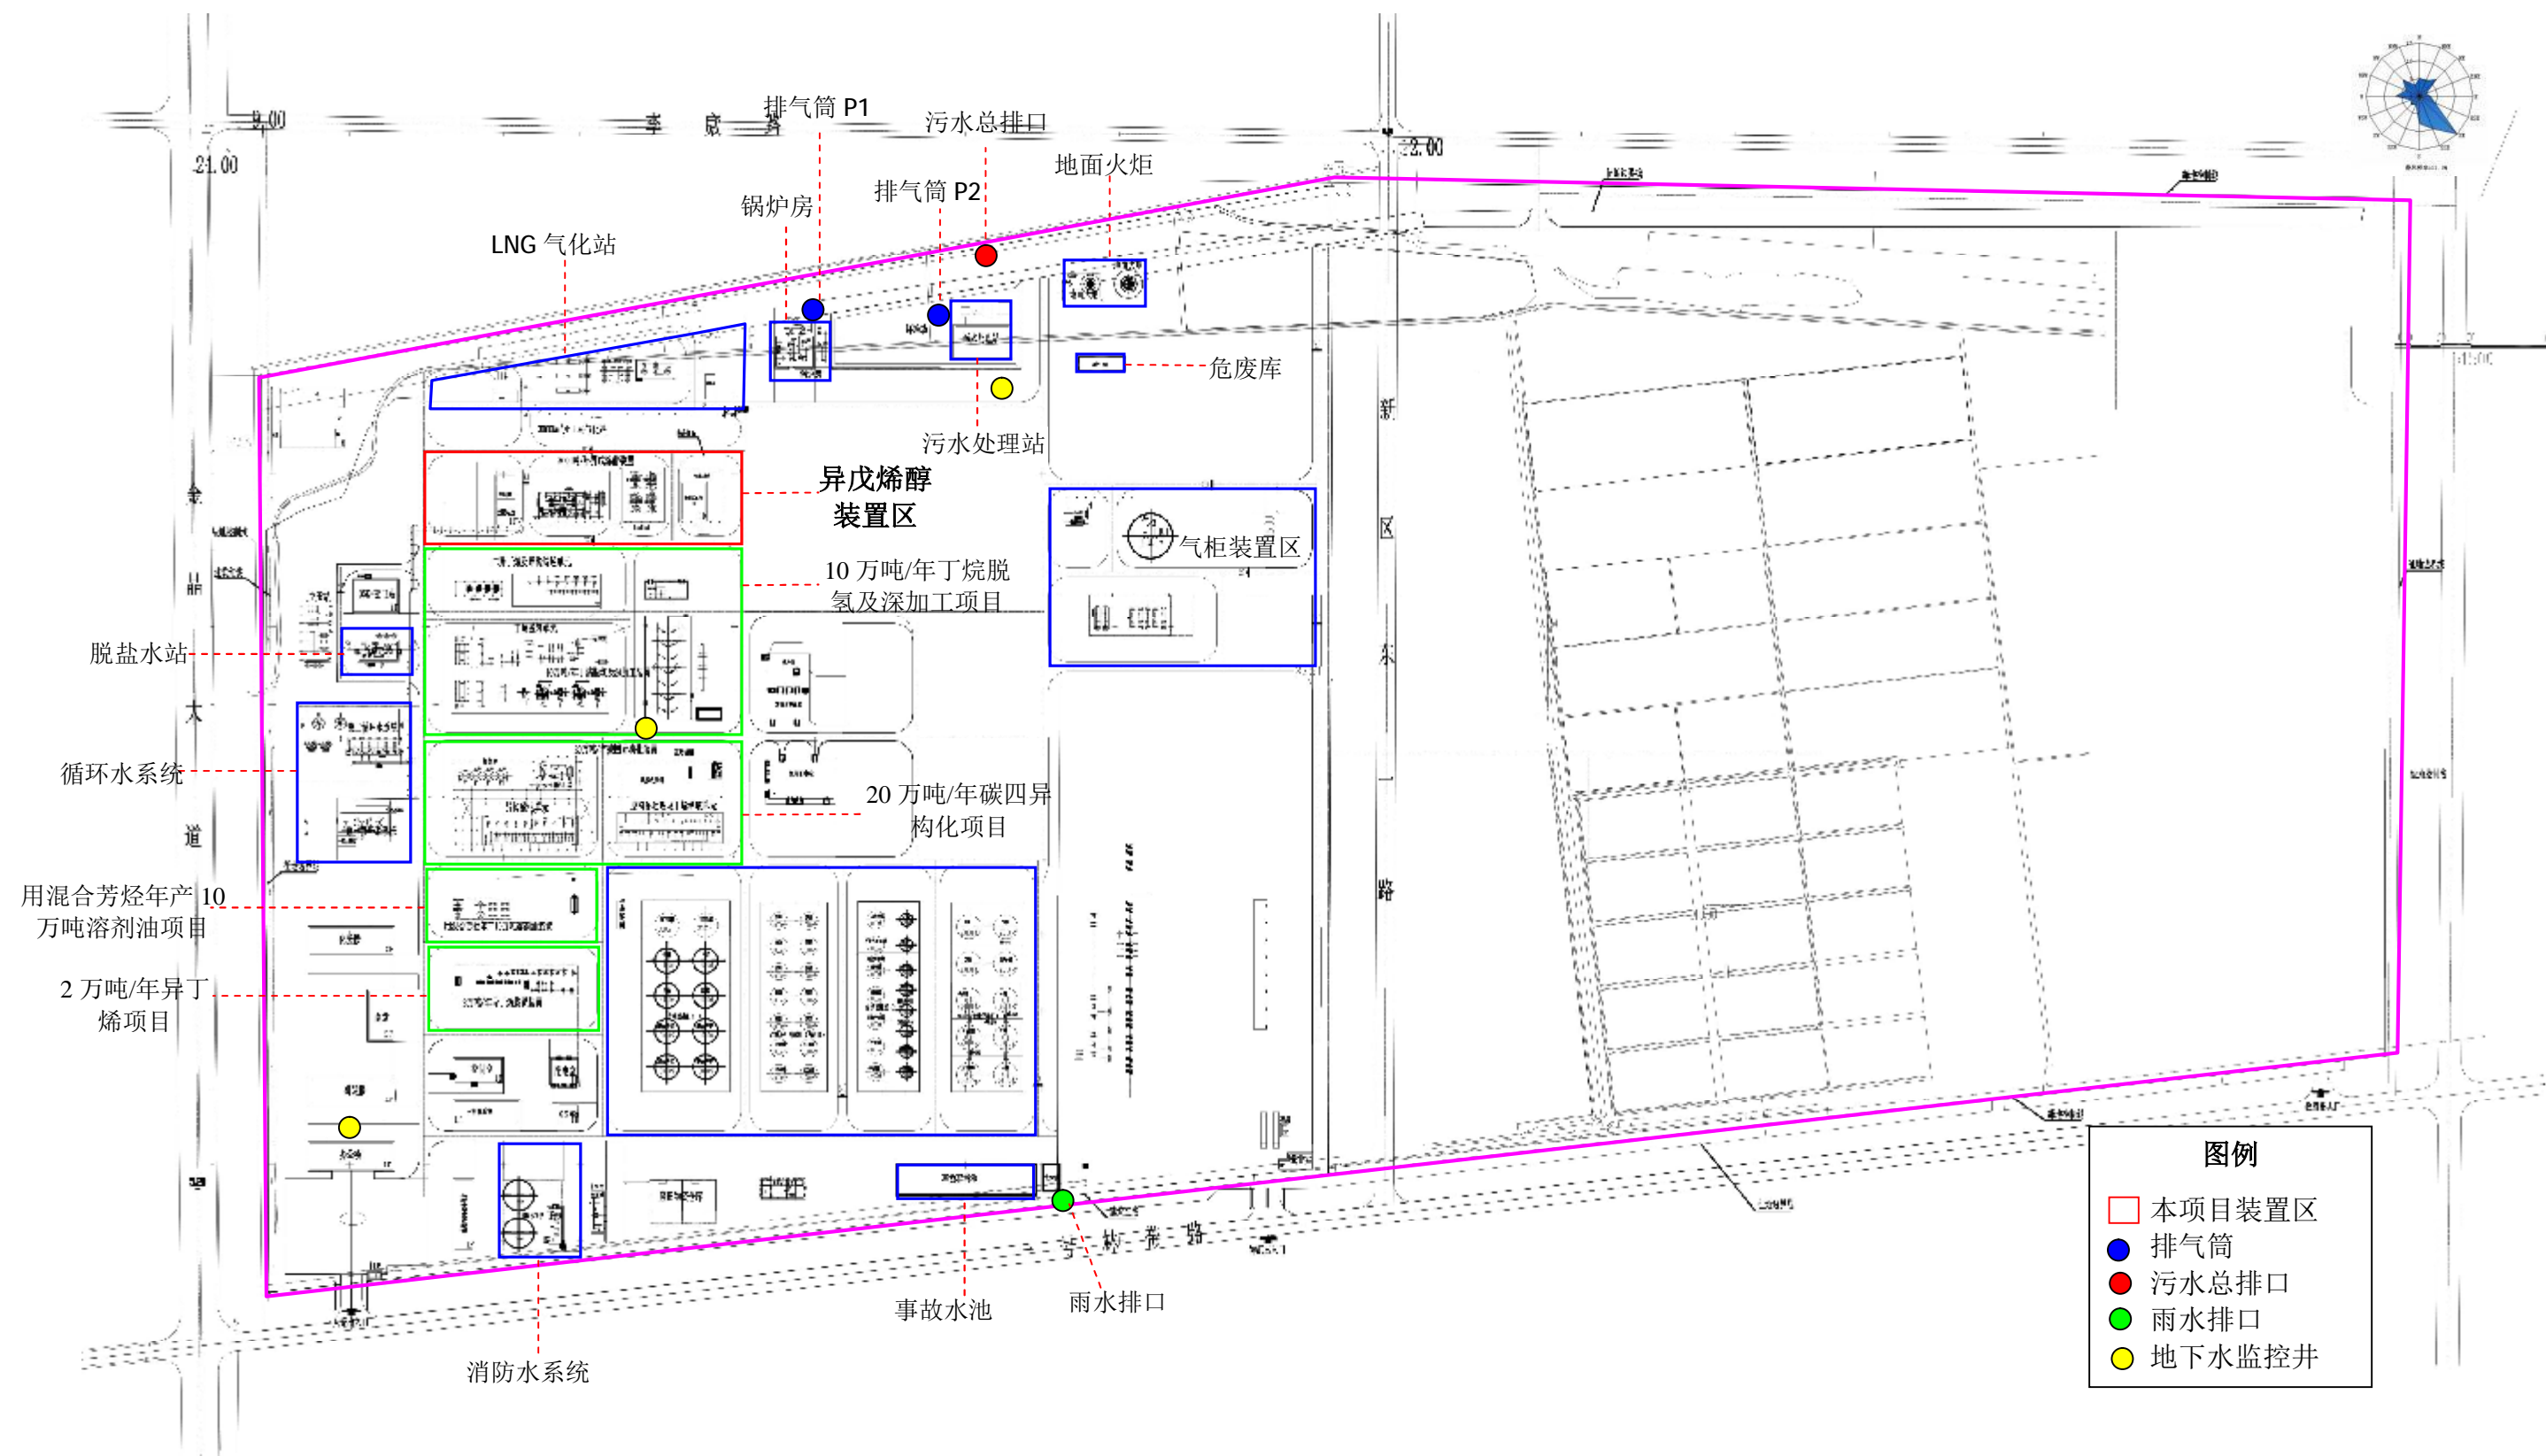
全厂总平面布置图 比例尺 1: 4290
